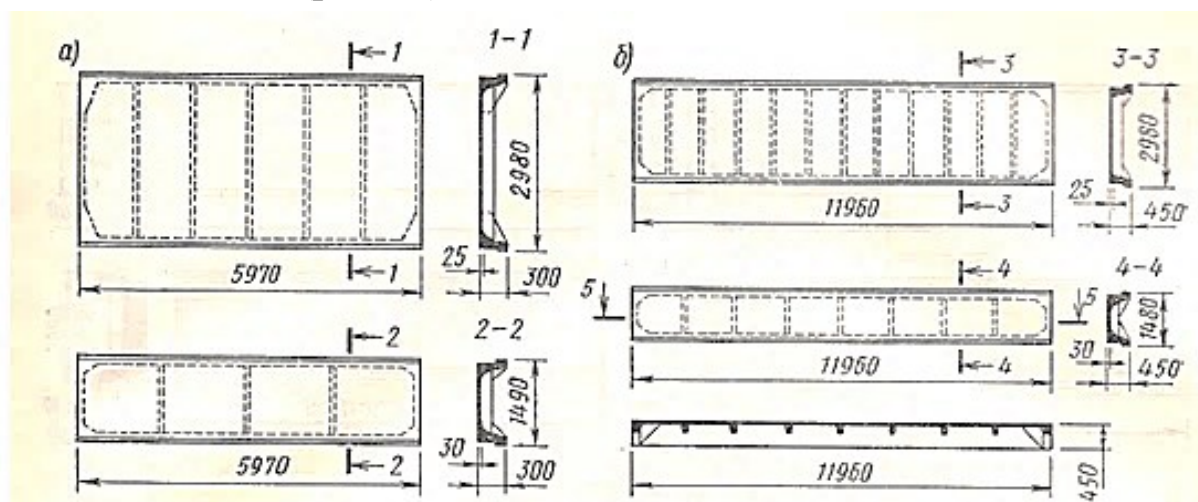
Крупноразмерные железобетонные плиты покрытий:
